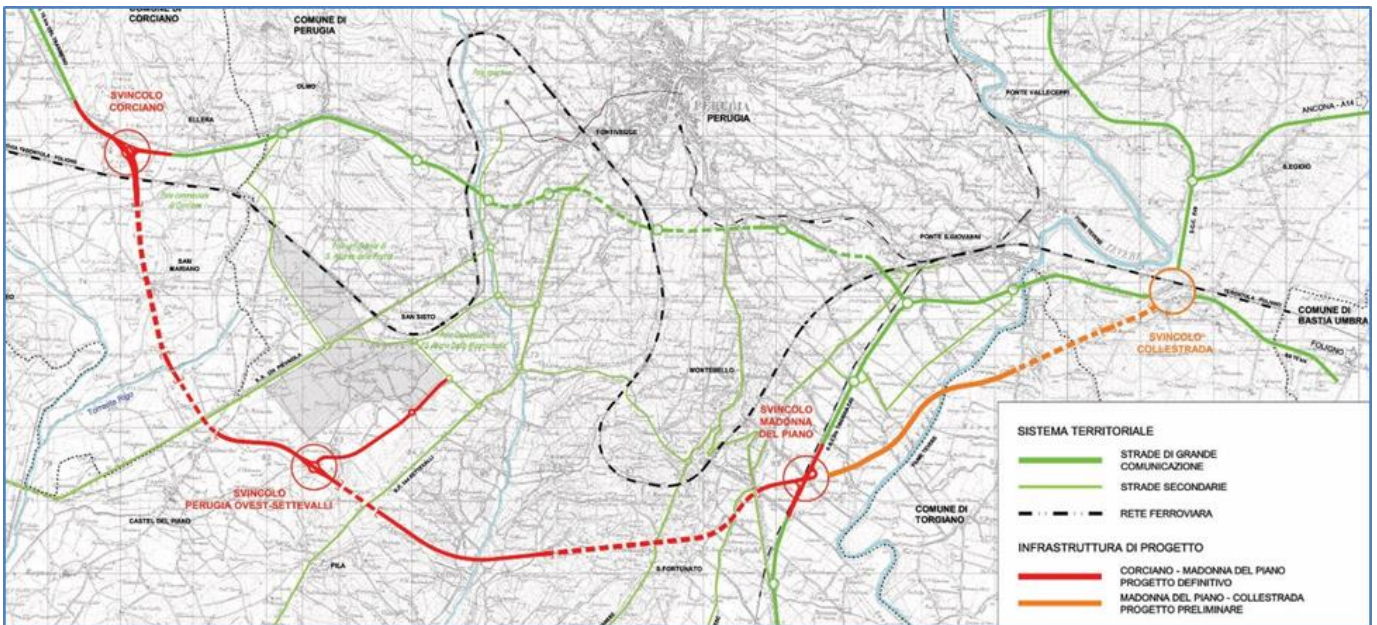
Progetto Preliminare: planimetria generale con individuazione delle tratte del Nodo di Perugia
